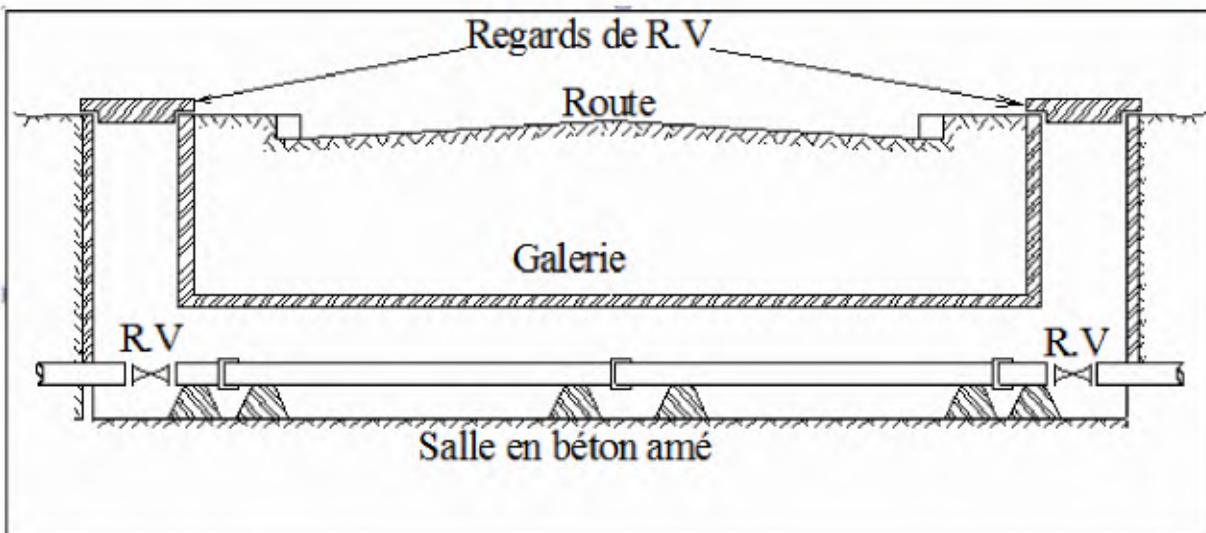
POSE DE CONDUITE DANS MAUVAIS TERRAIN.
